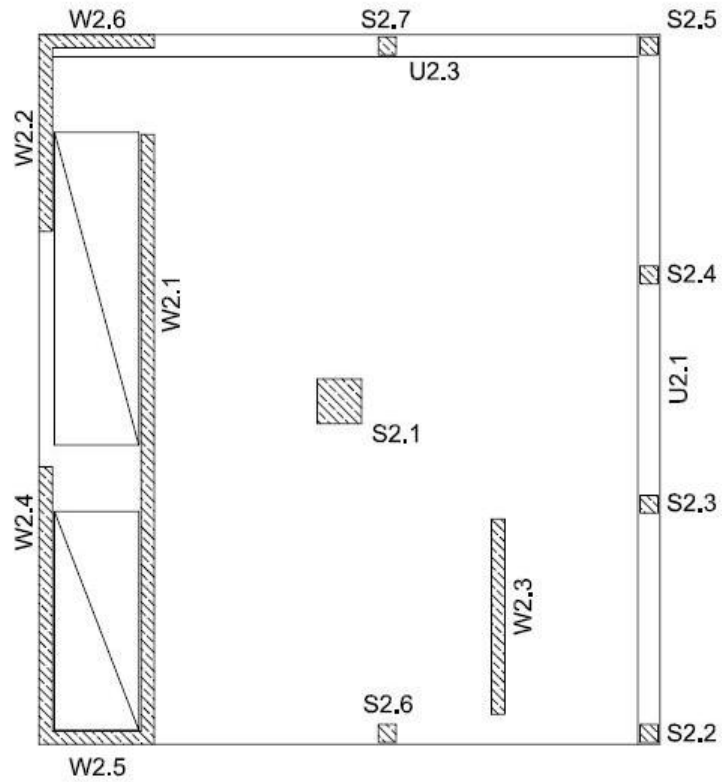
Bürogebäude X: Grundriss 1. OG [Lie09]
